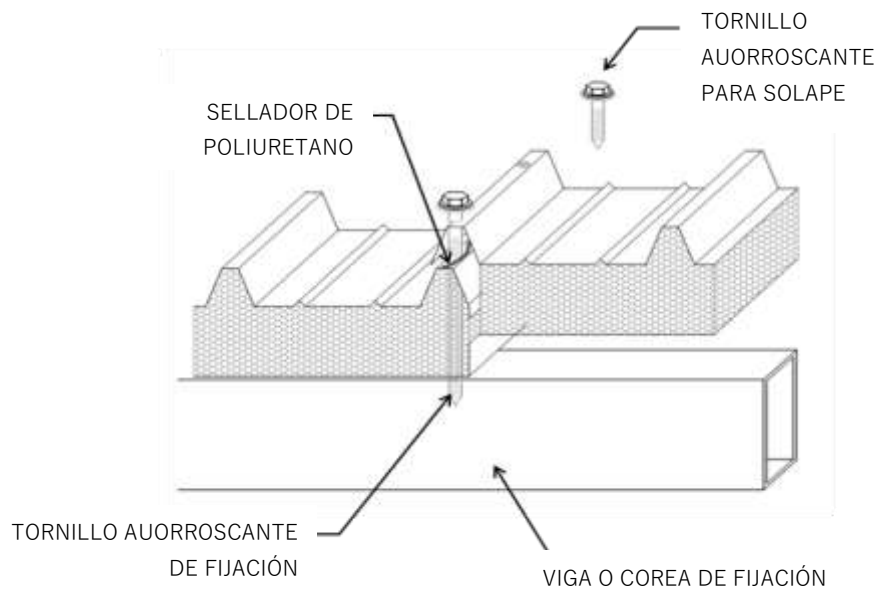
Fijación de Lamina Metálica de Techo a la estructura. Fuente: Manual de montaje de Termopanel®
